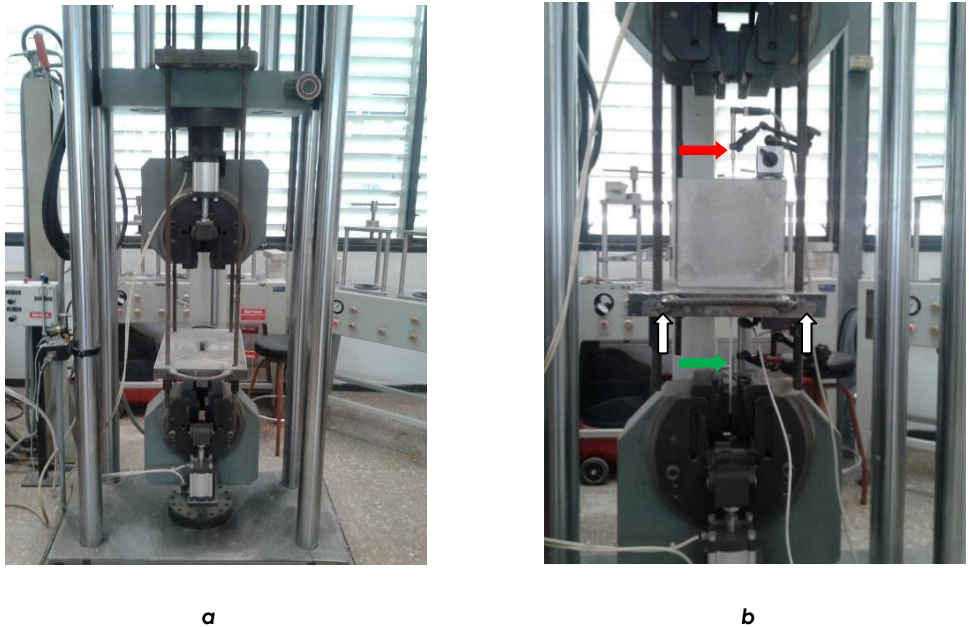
Máquina de ensayo pull-out, ACI-440-3R-04.
